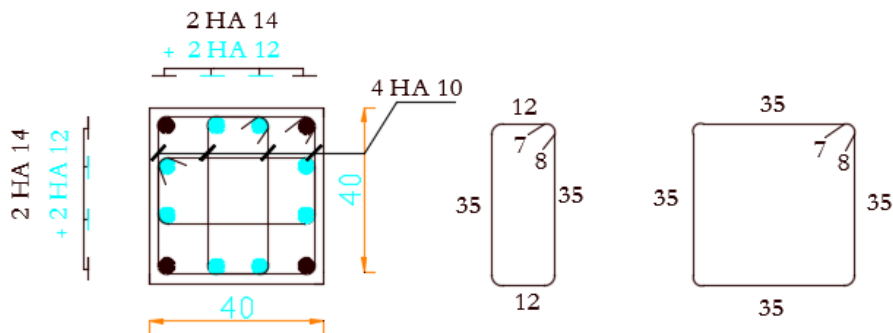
coupe transversale de ferrailage poteaux 40 x 40 cm²
